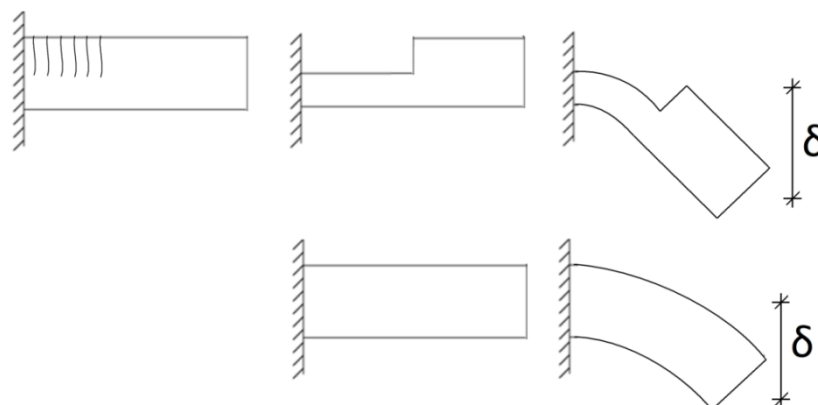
Betongen mellan sprickorna medverkar i kraftöverföringen. (Byggkonstruktion, 2005, s 448)
